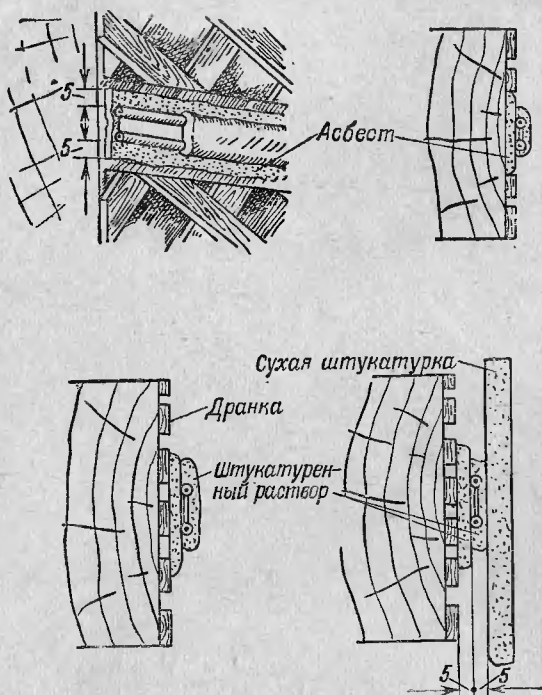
Прокладка провода скрыто по деревянному основанию.
